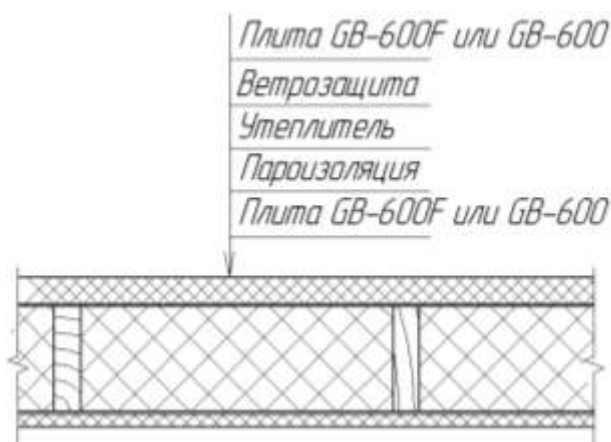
Конструкция стены без покрытия в разрезе. Вид сверху.
